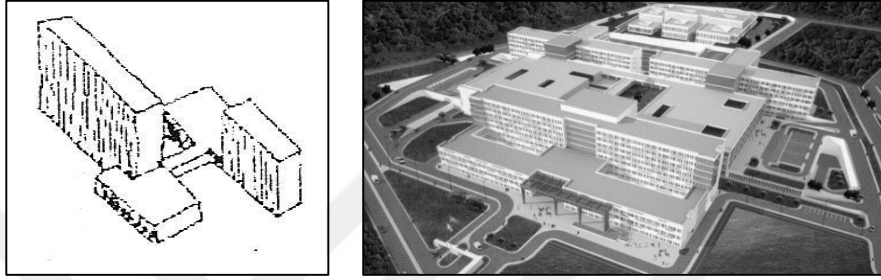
Blok sistemi hastane plan örnekleri (Aydın, 2009)
